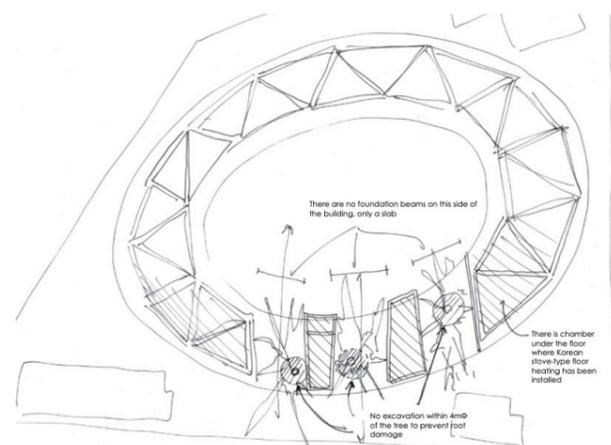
Esquema en planta de situación de los árboles y las modificaciones en la estructura.
